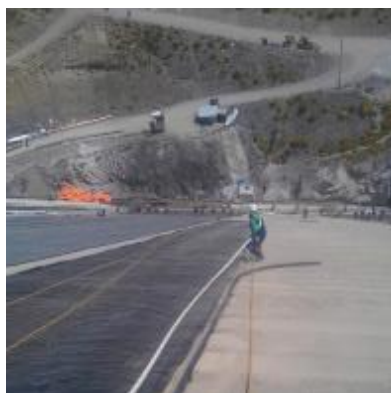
Tubería definitiva MM-01 subiendo sobre la cara del estrudado.
